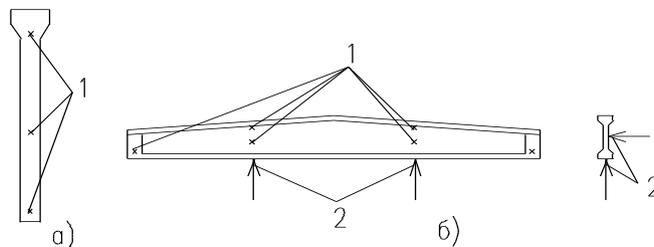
Примеры расположения участков испытания для определений прочности бетона и армирования в колоннах (а) и строительных балках (б): 1 - прочности бетона, 2 - армирования
